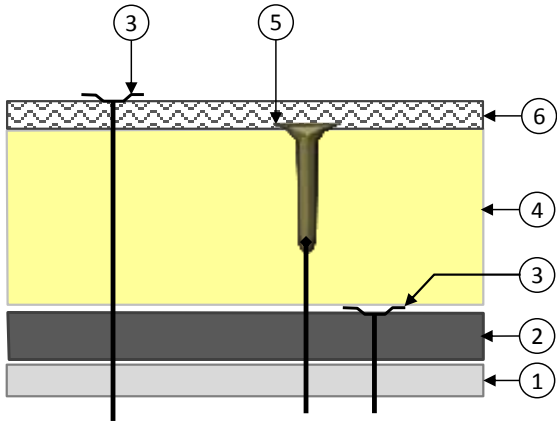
a - Illustration des fixations à rupteur de ponts thermiques sur TAN ou sur bois
